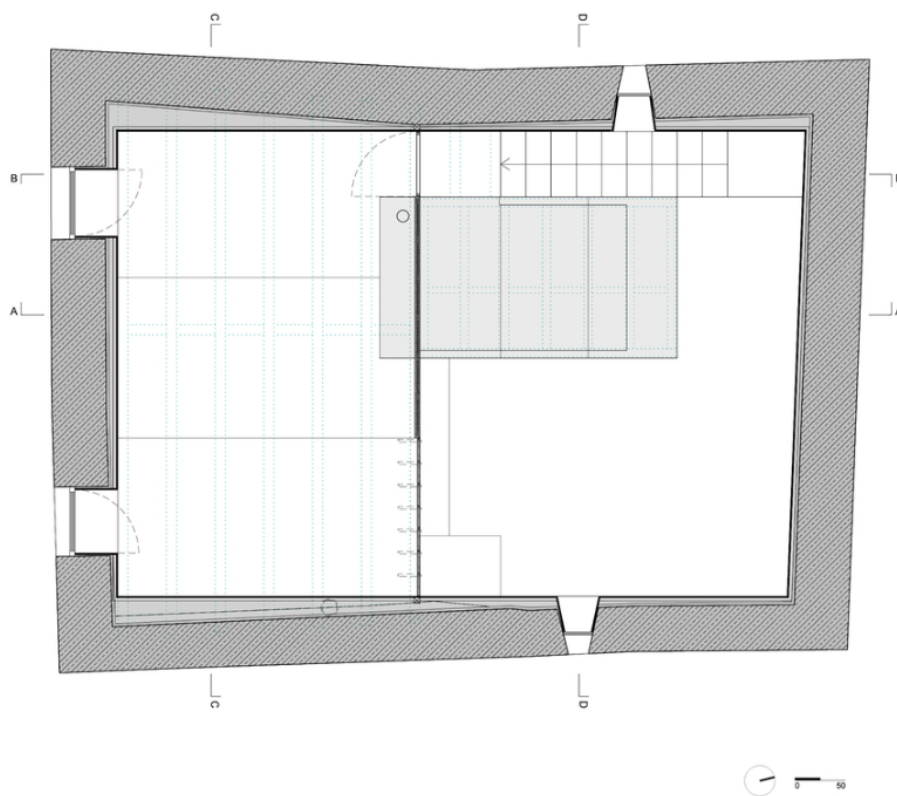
Planta do Piso 1 - Casa das Nogueiras
